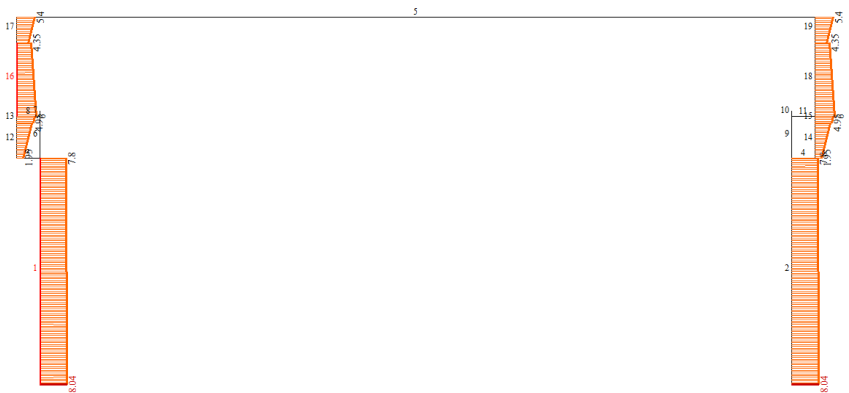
Відображення кутової арматури $AU1 - AU4$ у режимі «епюри армування у стержнях»
